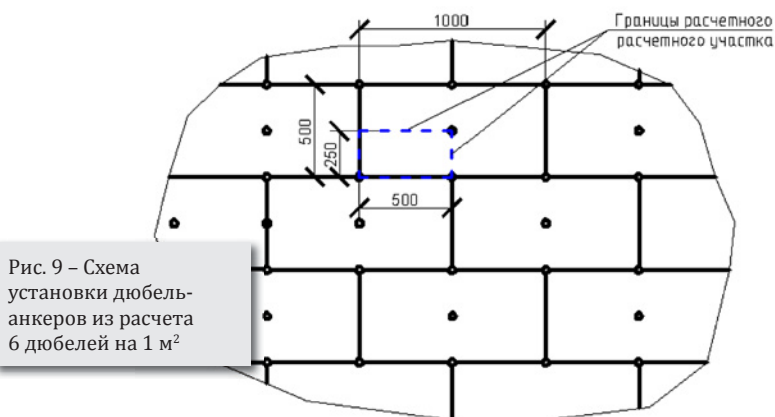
Схема установки дюбель-анкеров из расчета 6 дюбелей на 1 м²
